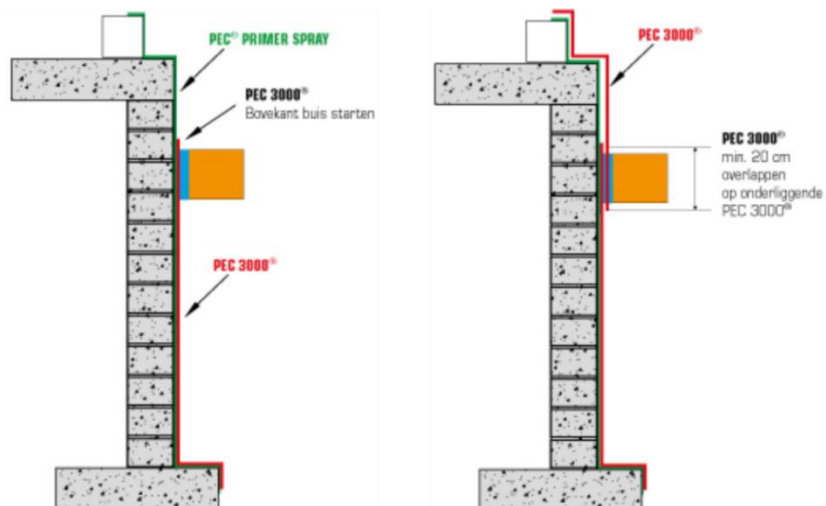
Waterdichting ter hoogte van doorvoeren in gemetste kelderwanden
